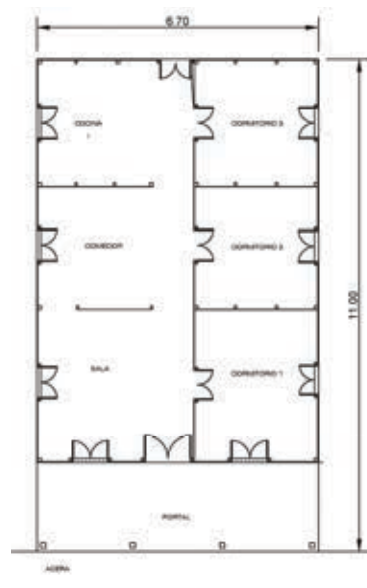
Planta de las casas construidas por la Asociación de Fabricación La Crecherie. Fuente: Autor.
